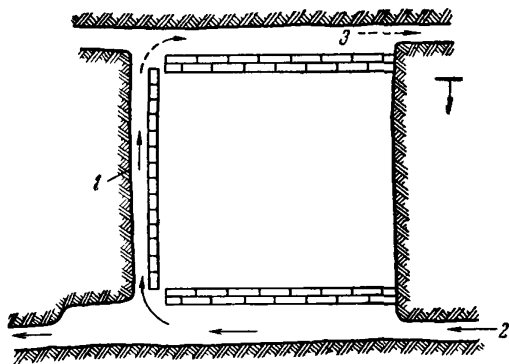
Перегородки по падению и простиранию для направления вентиляционной струи воздуха вдоль рабочего забоя:
